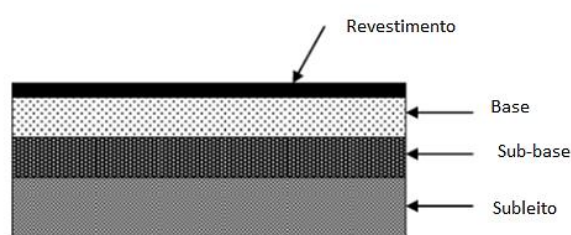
Estrutura típica de um pavimento (Lam et al., 2010).
